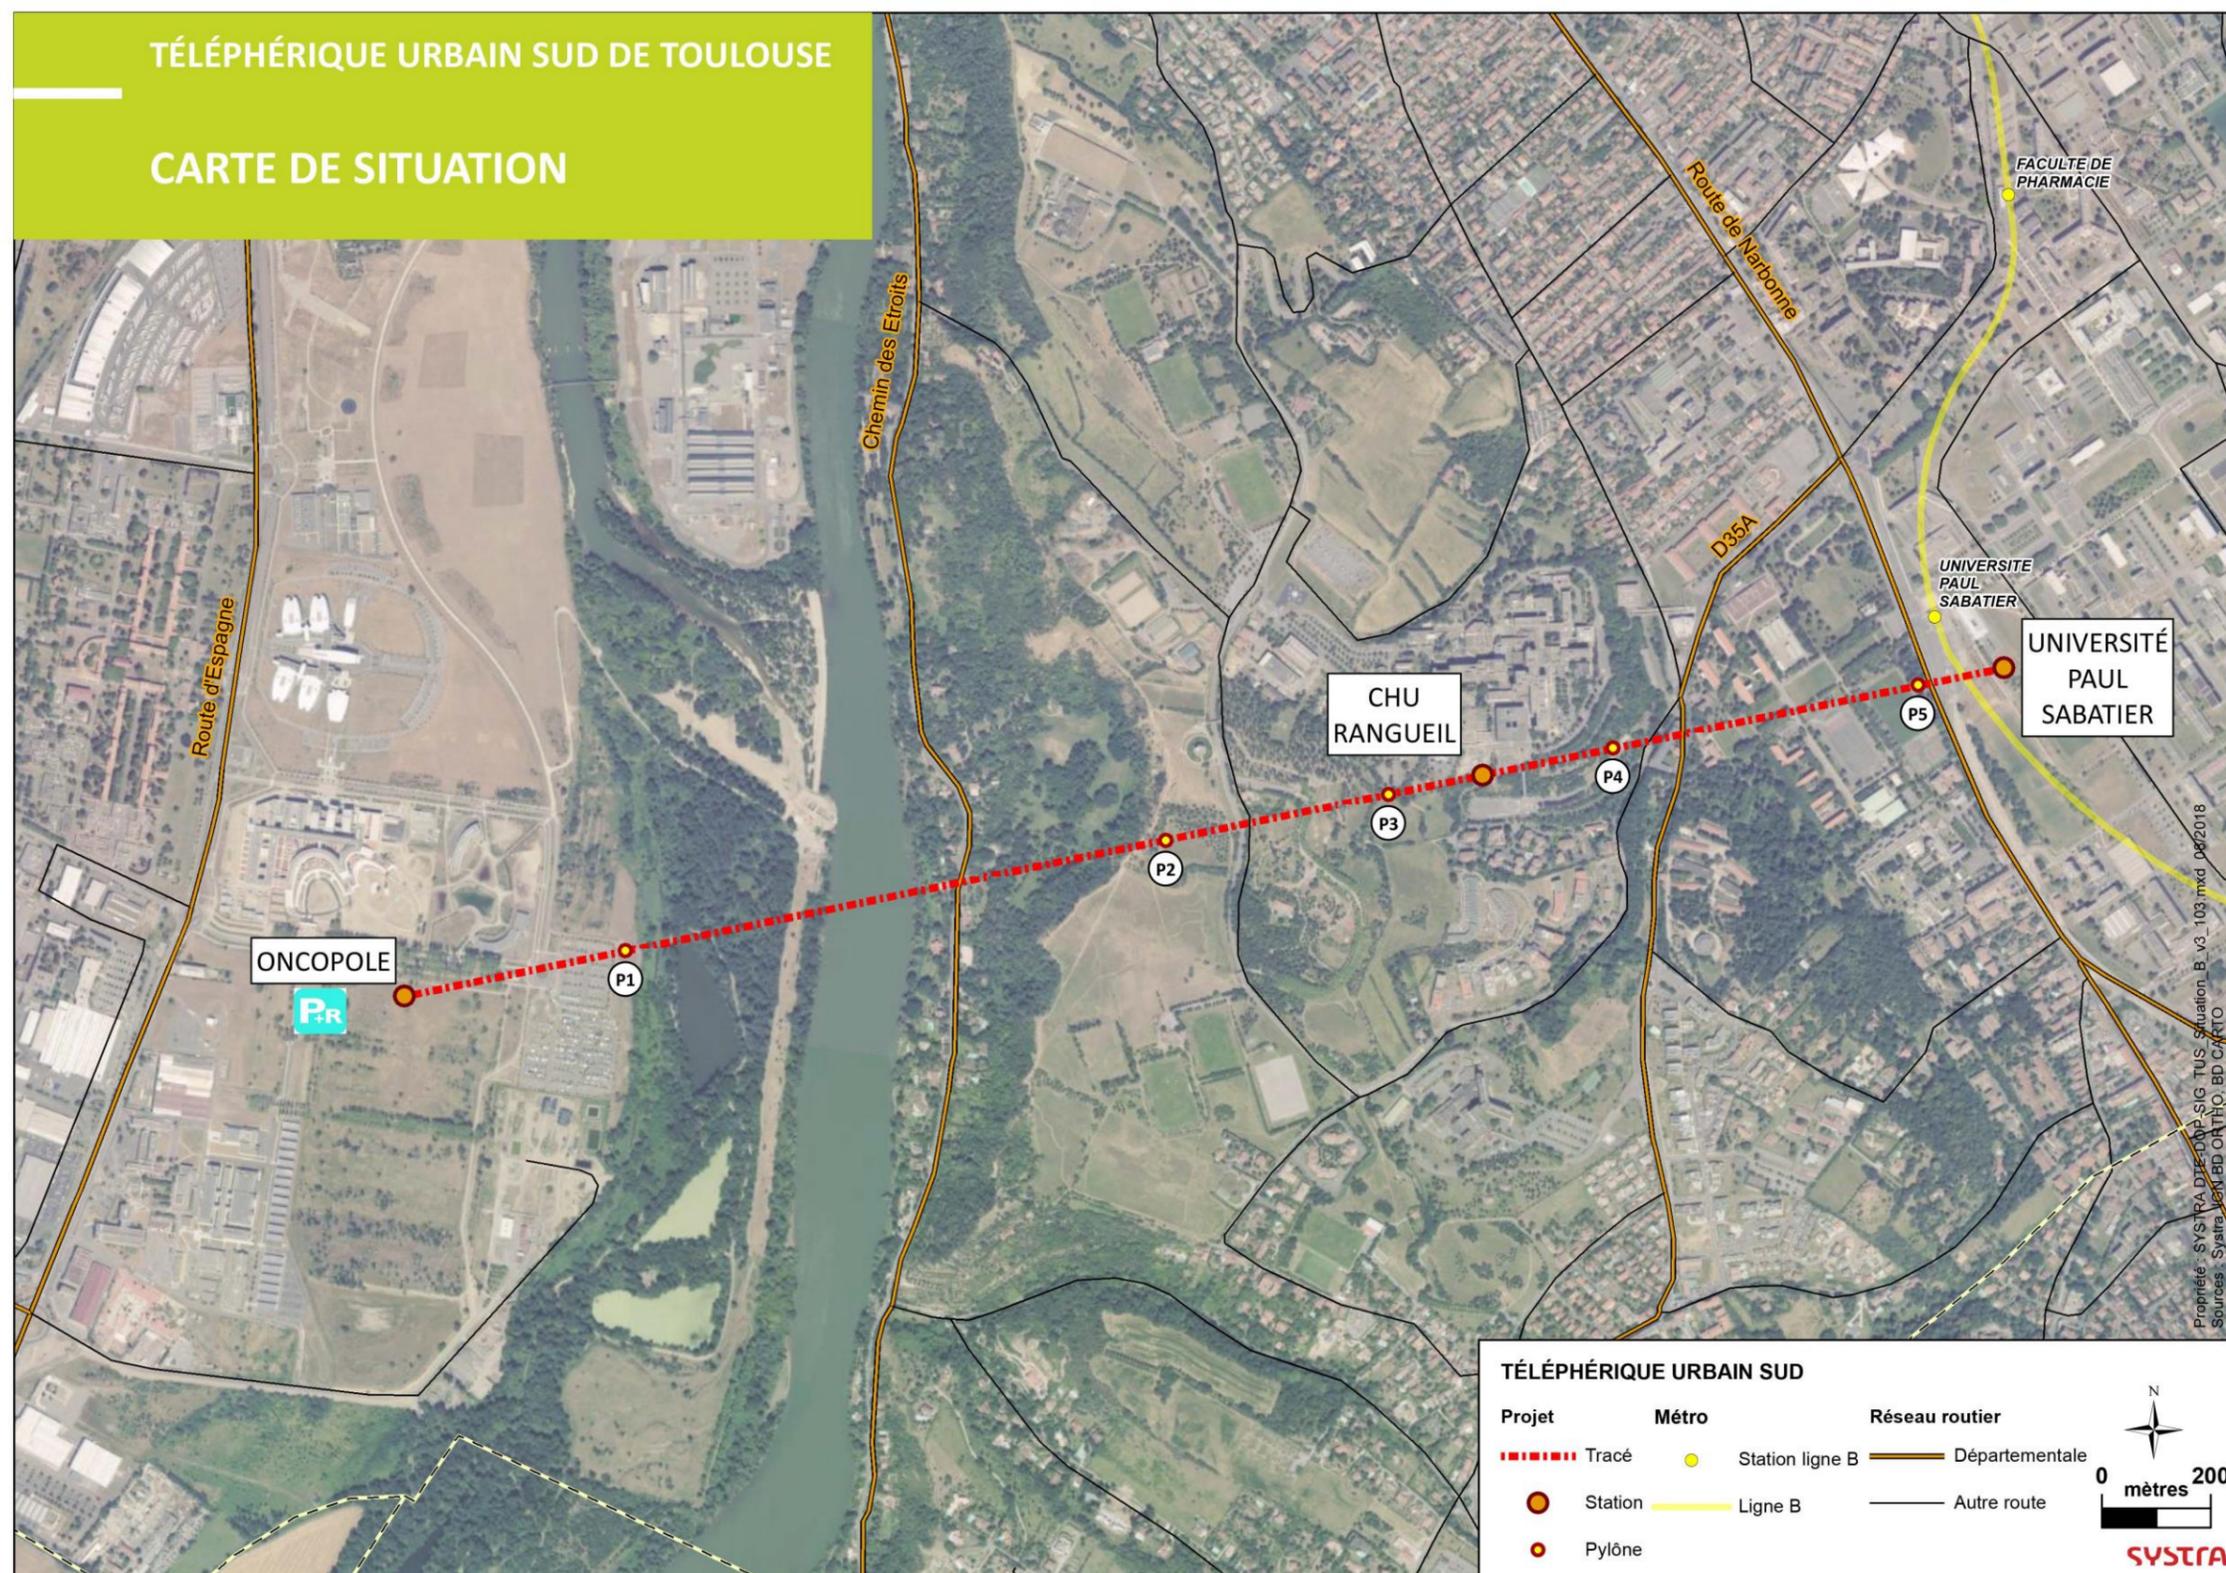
Plan de situation du projet au 1/10000 (source : Groupement POMA, 2018)
